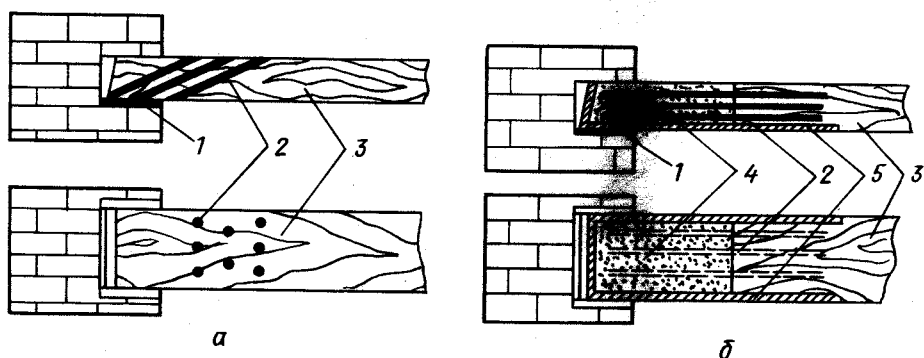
Схемы усиления опорных частей балок перекрытий посредством арматурных стержней
